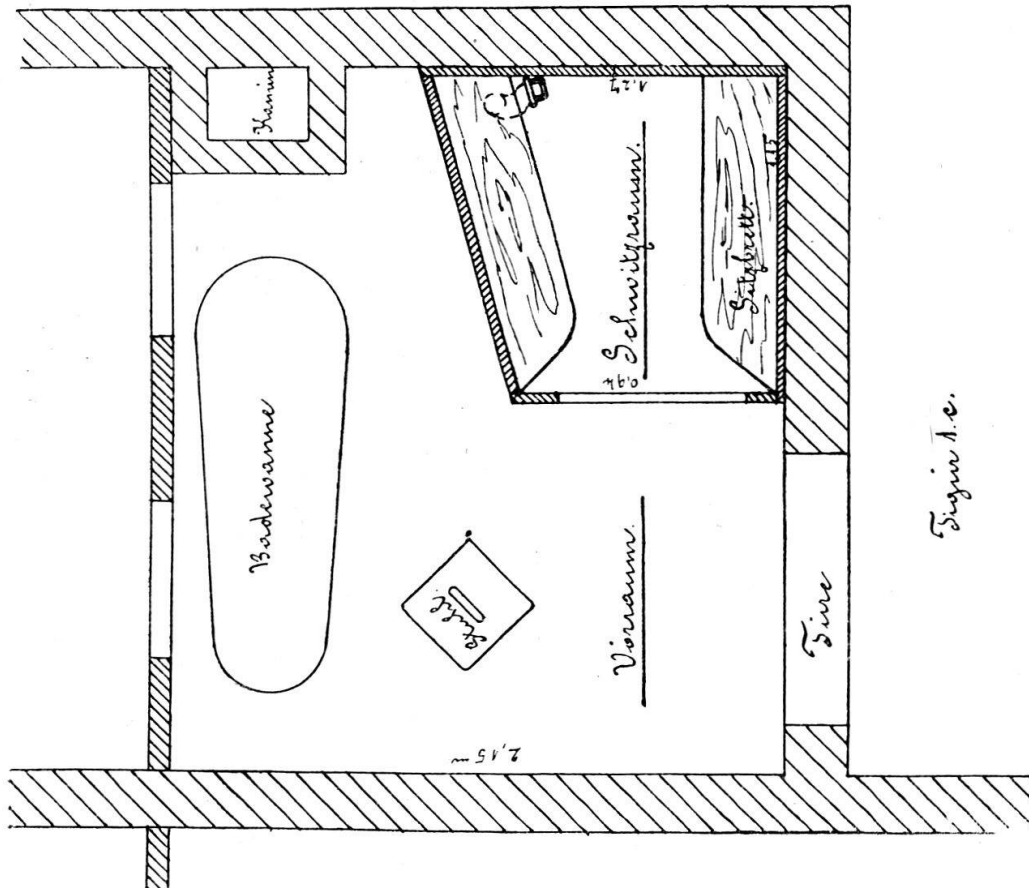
c. Grundriss der behandelten Schwitzstube.
